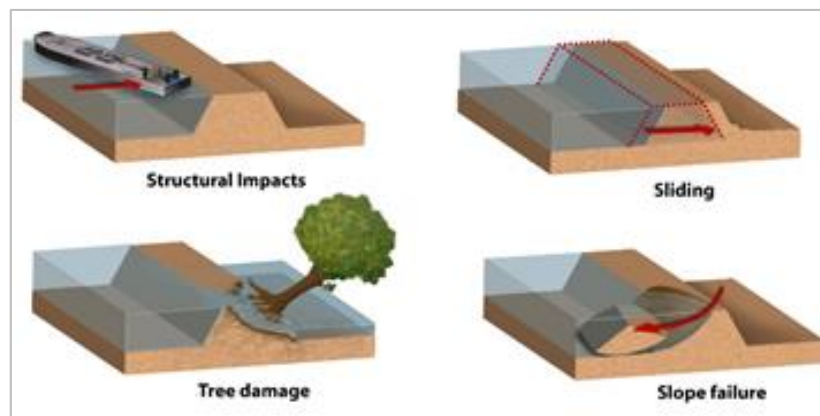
Fallas estructurales. Fuente: Deretsky, 2006.
